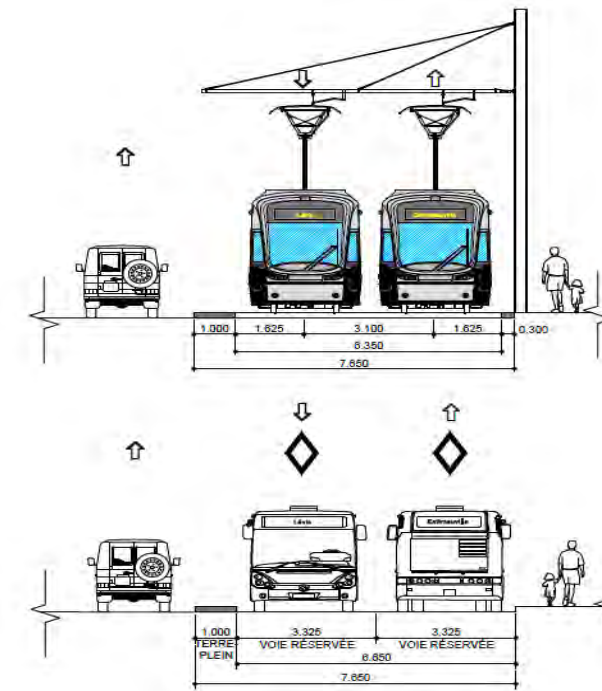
Coupe 04 de 15 - SRB - Site espace restreint - Insertion latérale
